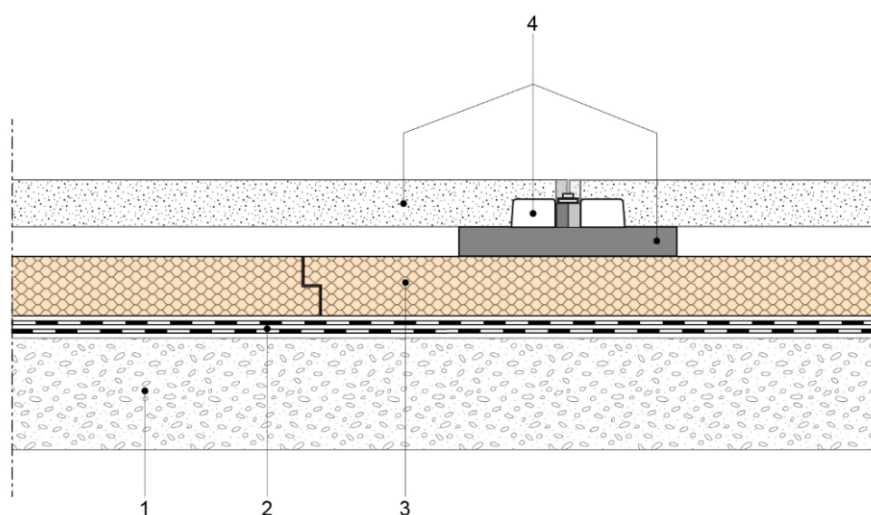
Joint de gros œuvre placé au point haut de la toiture terrasse – Cas des véhicules légers – Pente ≥ 2 %
